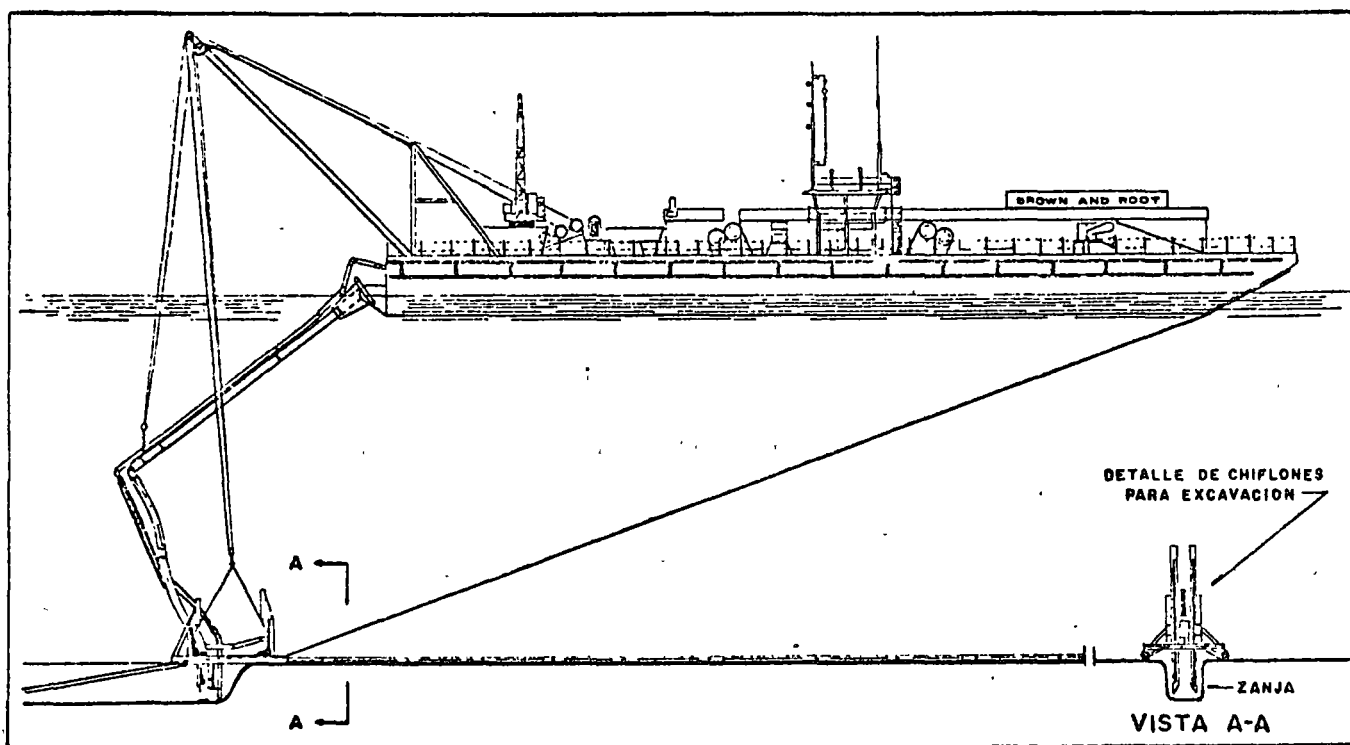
A.- DETALLE TIPICO DE BARCAZA CON EQUIPO PARA EXCAVACION EN EL FONDO DEL MAR
